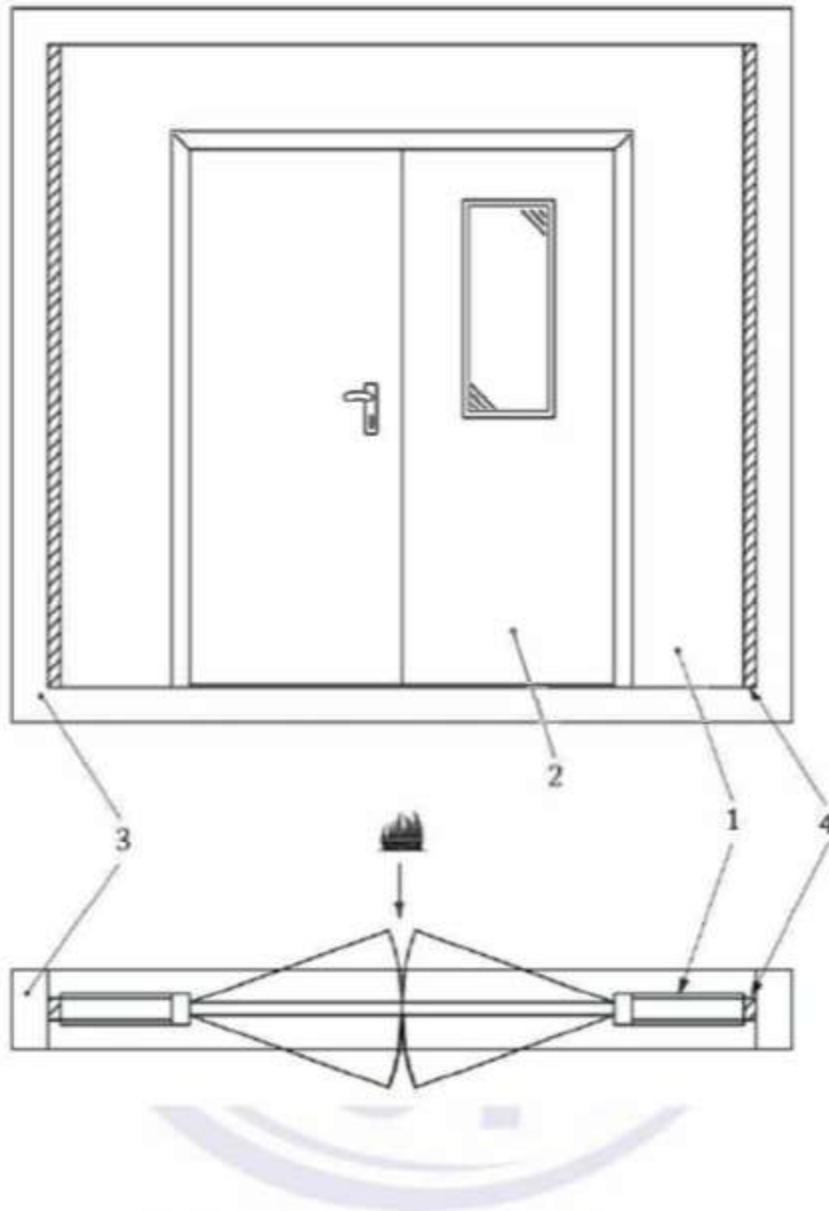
Exemplo de seção transversal horizontal de uma construção de suporte padronizada flexível
